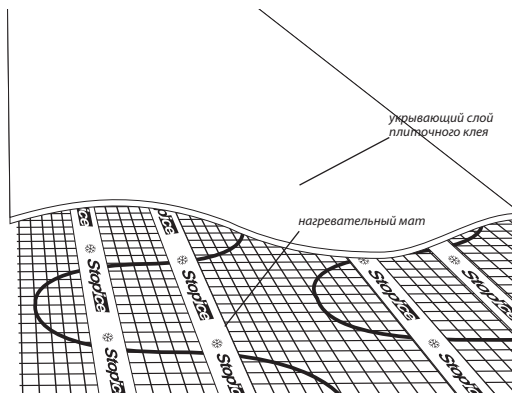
Заливка нагревательного мата раствором для крепления плитки
